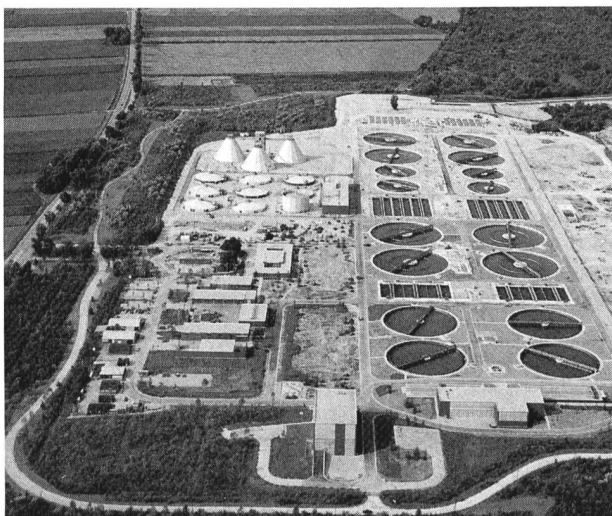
Das Klärwerk München II mit 32 rissfreien Betonbauwerken ohne Dehnungsfugen.
